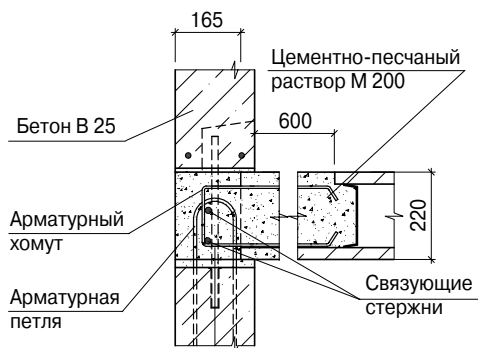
Пример соединения типовых плит перекрытия с панелями наружных стен
